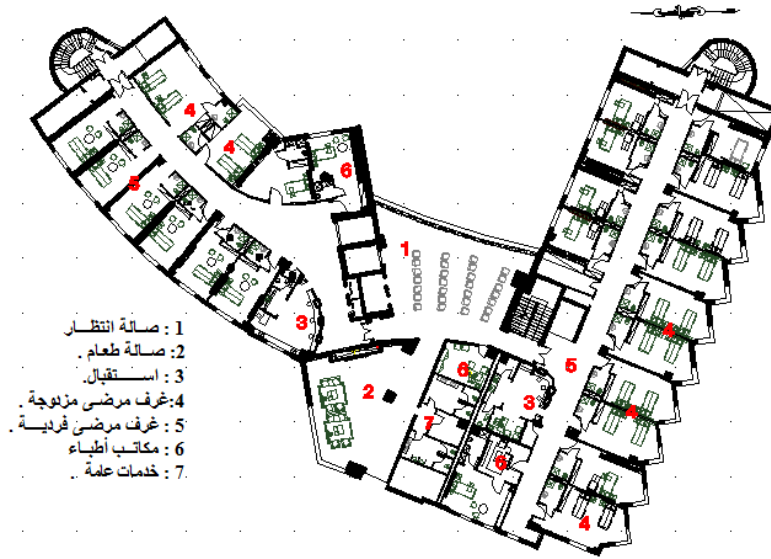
مسقط الطابق الأول للمستشفى .
